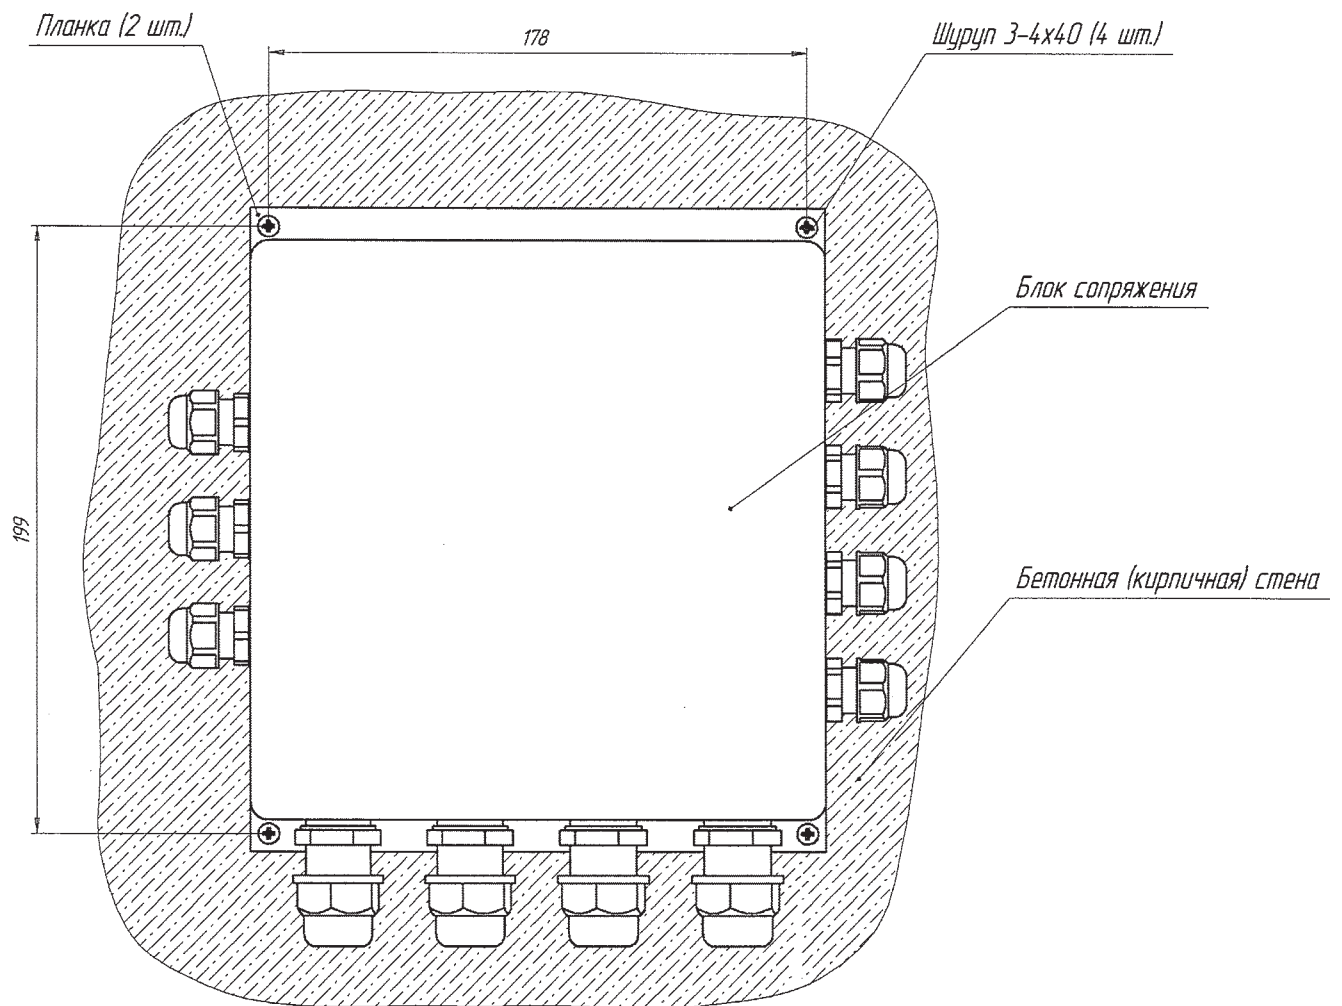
Внешний вид блока сопряжения, установленного на плоской поверхности (стене)
